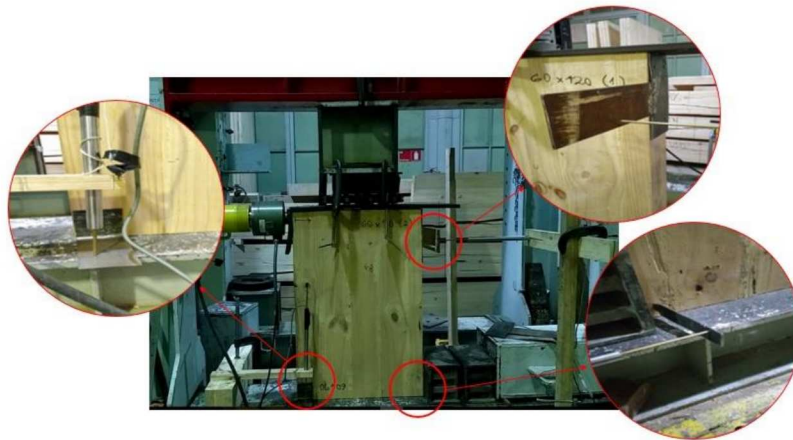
Montaje típico de probeta de CLT tipo muro para ensayo de corte en el plano.
